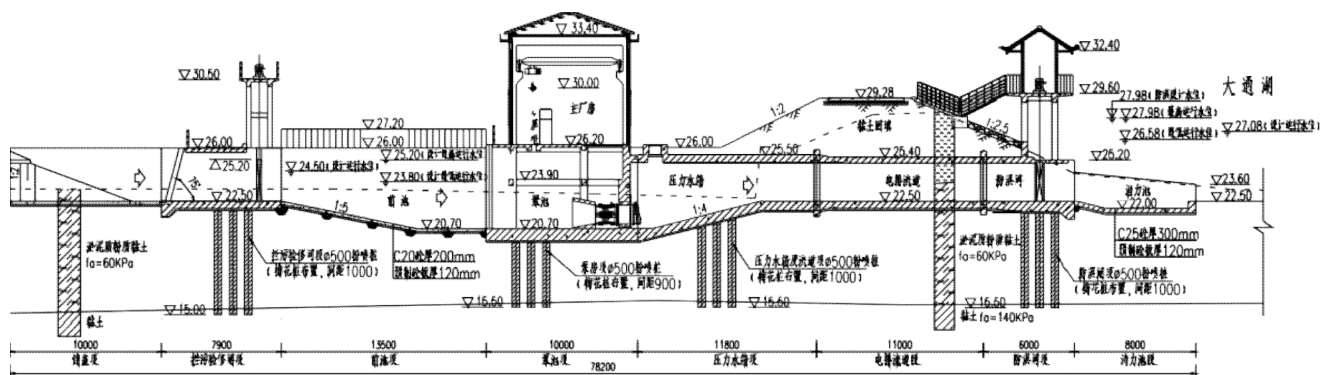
泵站纵剖面图 高程单位 m, 尺寸单位 mm
